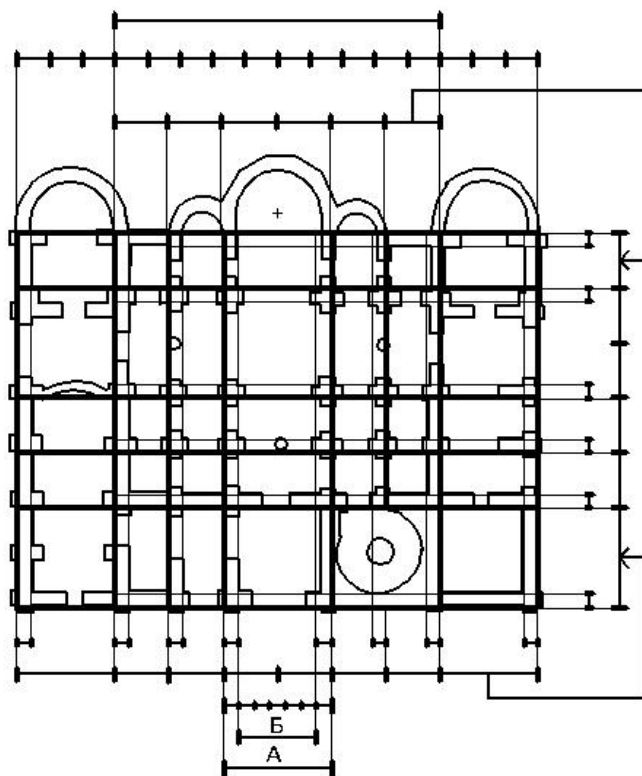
Разбивка плана с определением дополнительных размеров на строительной площадке.
